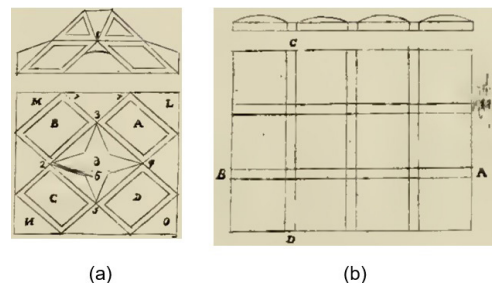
Abobadilhas tipo alentejanas volteadas a partir de vigas de madeira: (a) Variante 1: vigas de madeira no contorno dos retângulos, alçado (em cima) e planta (em baixo); (b) Variante 2: vigas de madeira A, B, C, D, alçado (em cima) e planta (em baixo) (Guarini 1737)
